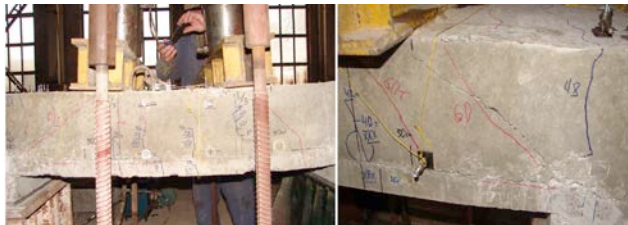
Схема випробувань залізобетонної плити незнімними опалубками ПО-1,2,3
